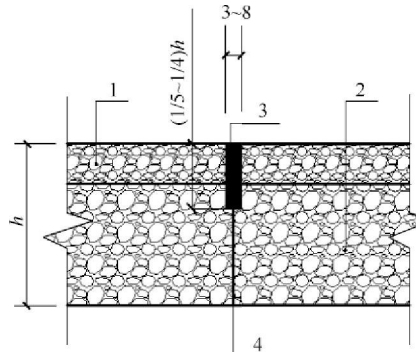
缩缝处的施工缝构造剖面图（单位：mm）
